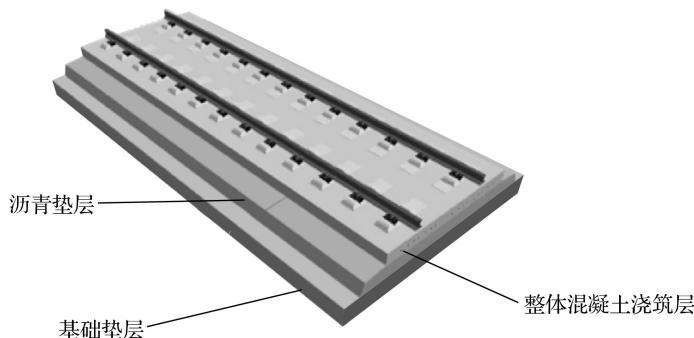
法国新干线宽轨枕无砟线路断面图(已浇筑混凝土)
